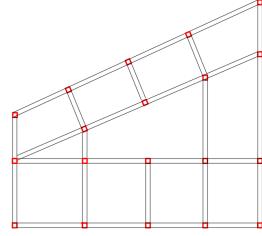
Sistema aporticado mixto Fuente: Archivo propio (2024)
